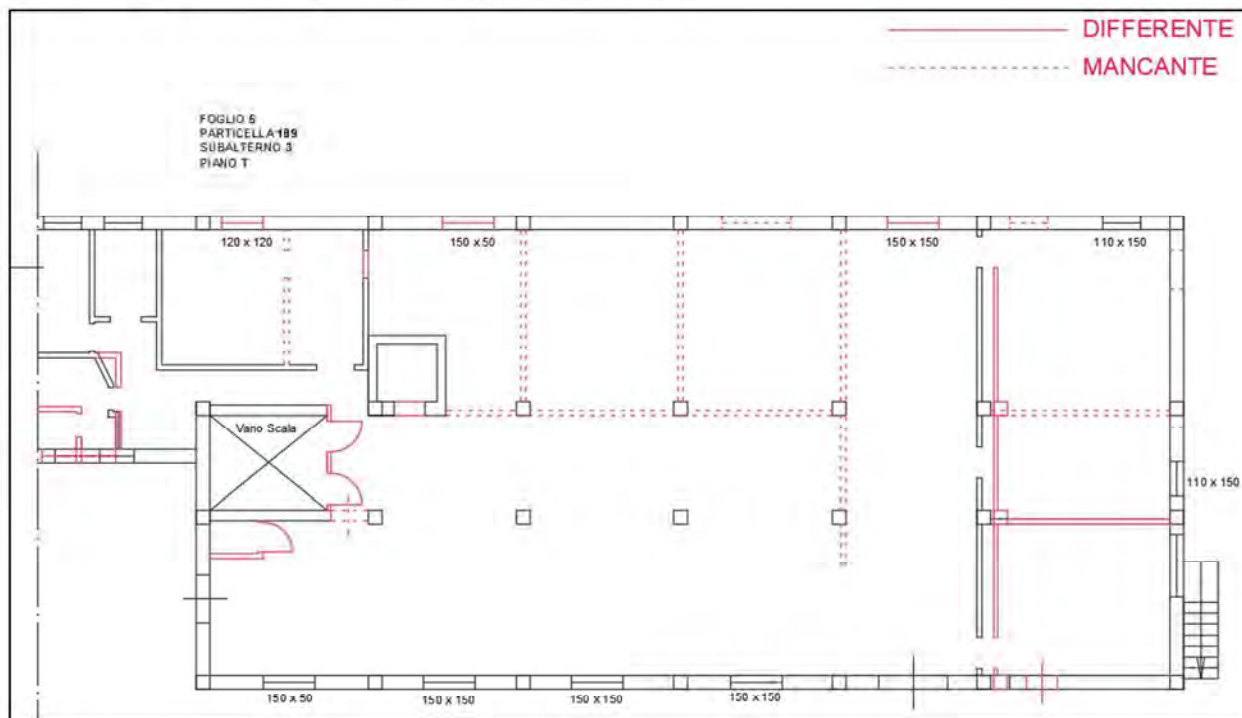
Planimetria incongruenze catastali Sub 3- Piano 0
